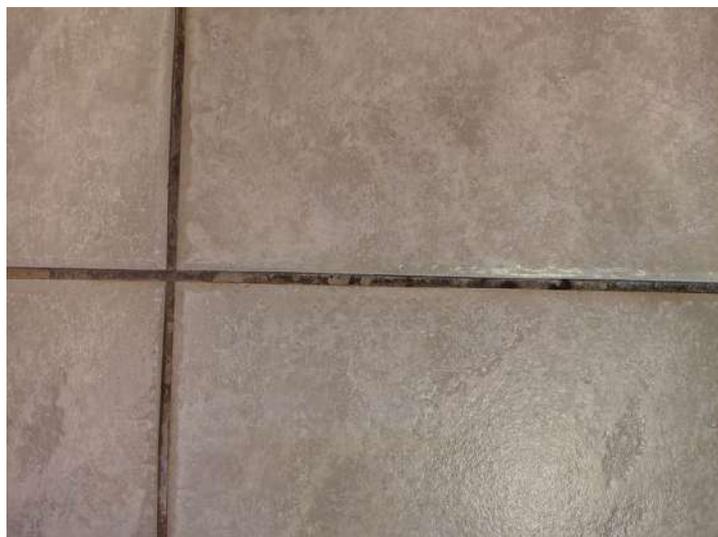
WC Feminino – Deterioração do rejuntamento do piso
